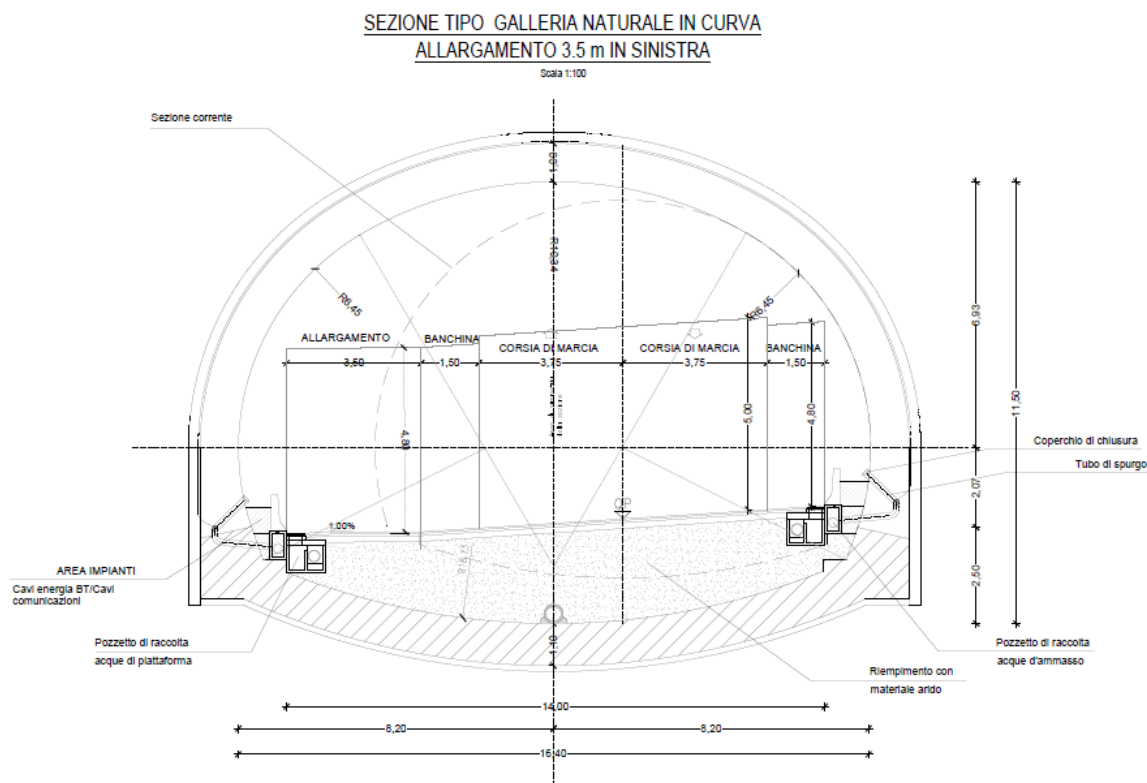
Galleria naturale, sezione tipo allargata 3.5 m.
